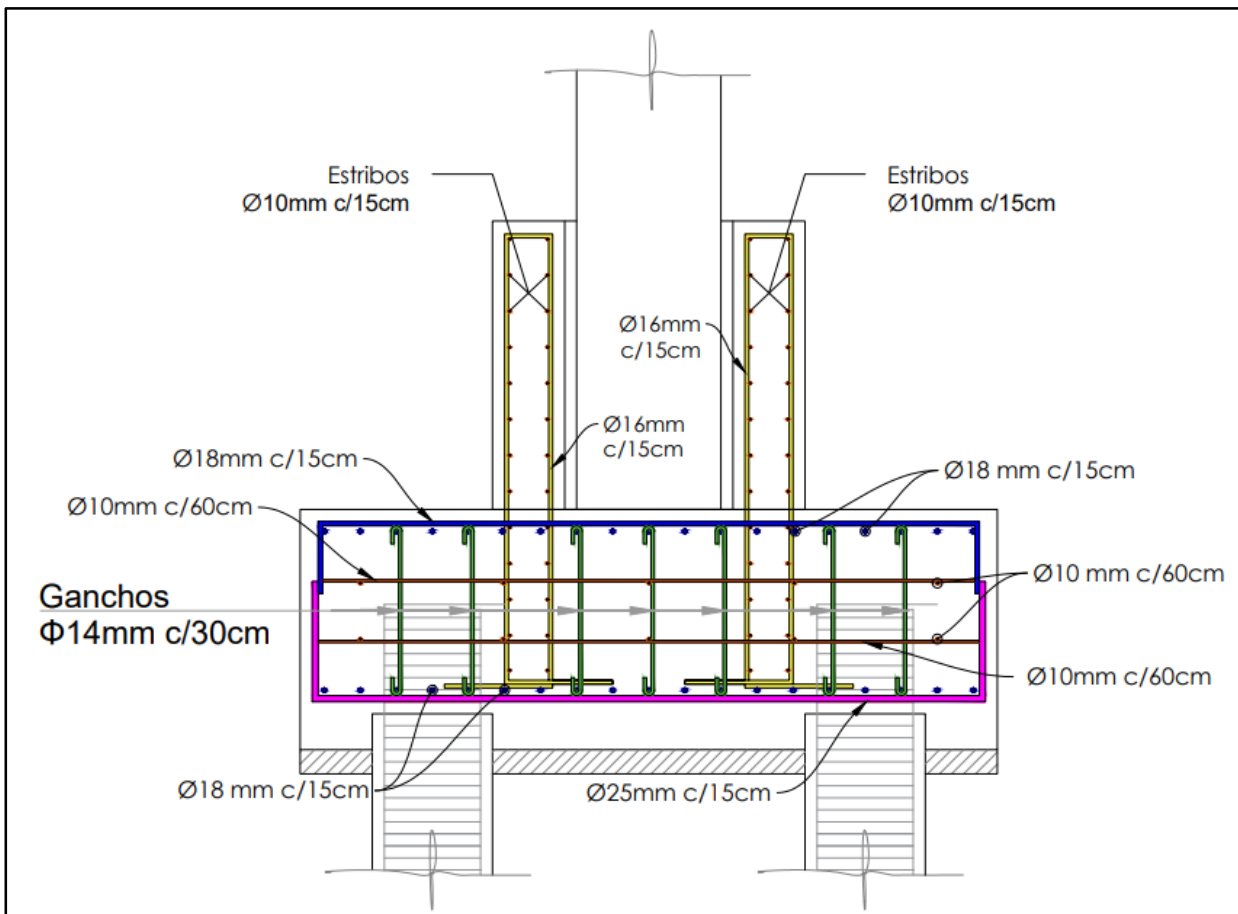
Armado de la zapata tipo candelero en el corte A-A'. Referente a la figura 18. Fuente del autor.
